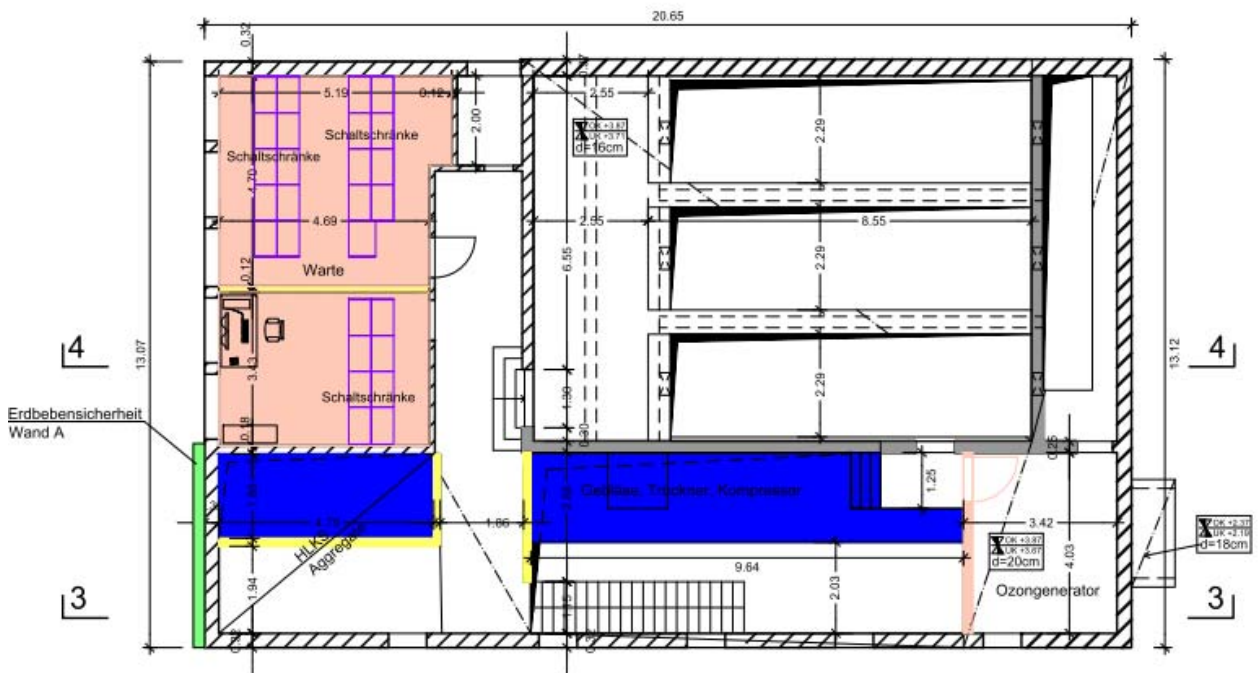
Grundriss OG Layout Raumkonzept
